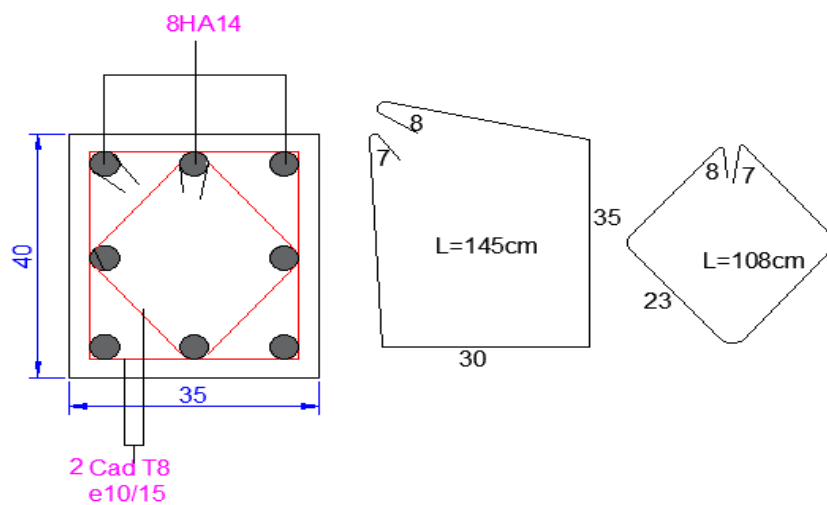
Schéma de ferrailage poteaux (35x40) :
